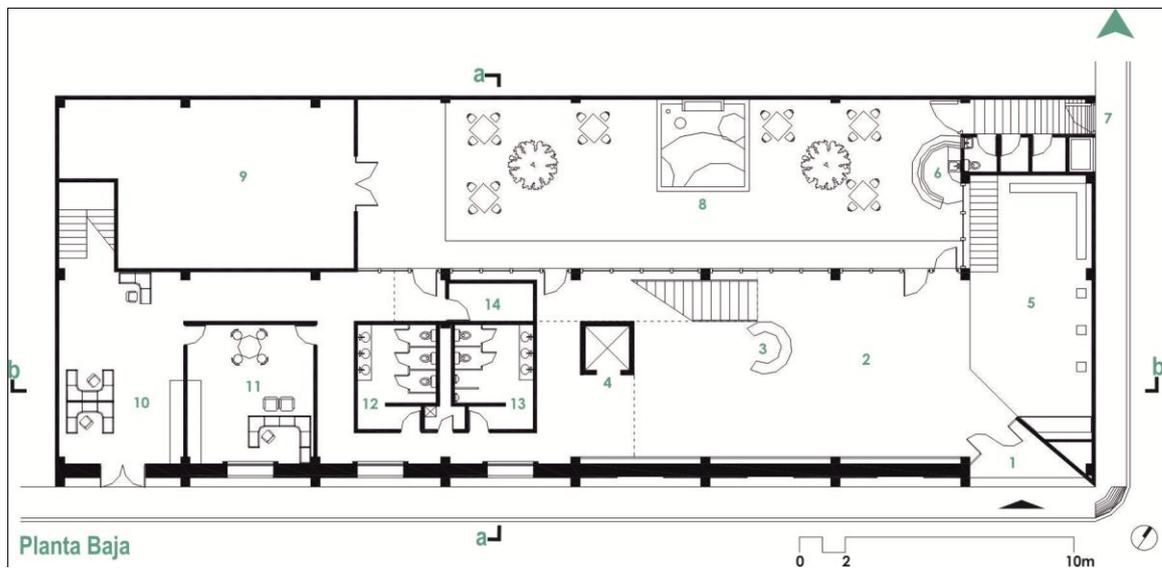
Partido arquitectónico opción “B”. Planta baja.
